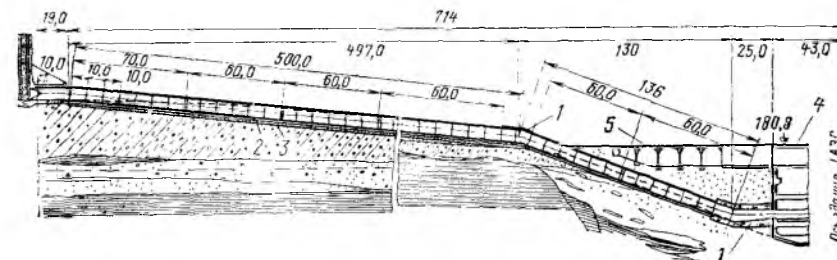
Сталежелезобетонные подводящие водоводы Загорской ГАЭС (вариант сборной конструкции).
